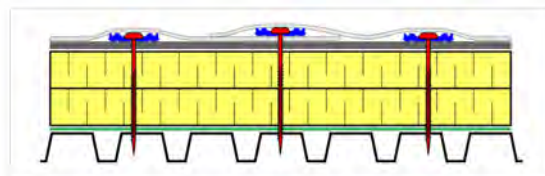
Extrait du site Internet du CNRC au 2021-09-01; système de toiture à membrane fixée mécaniquement
